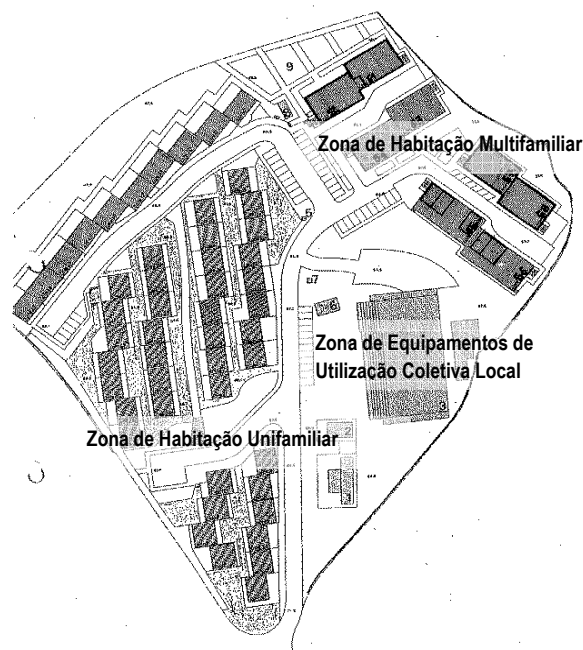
Planta do Bairro Olival do Pancas – situação existente
